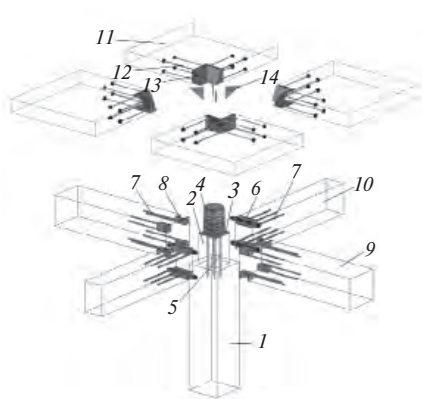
Схема сборки железобетонных строительных элементов: 1 – нижняя часть колонны; 2 – верхняя часть колонны; 3 – закладная деталь; 4 – цилиндрическое винтовое соединение; 5 – стальные стержни; 6 – затяжной винт; 7 – стальные стержни; 8 – сварной уголок; 9 – ригель первого типа; 10 – ригель второго типа; 11 – плита перекрытия; 12 – стальные стержни; 13 – закладные детали; 14 – металлическая пластина
